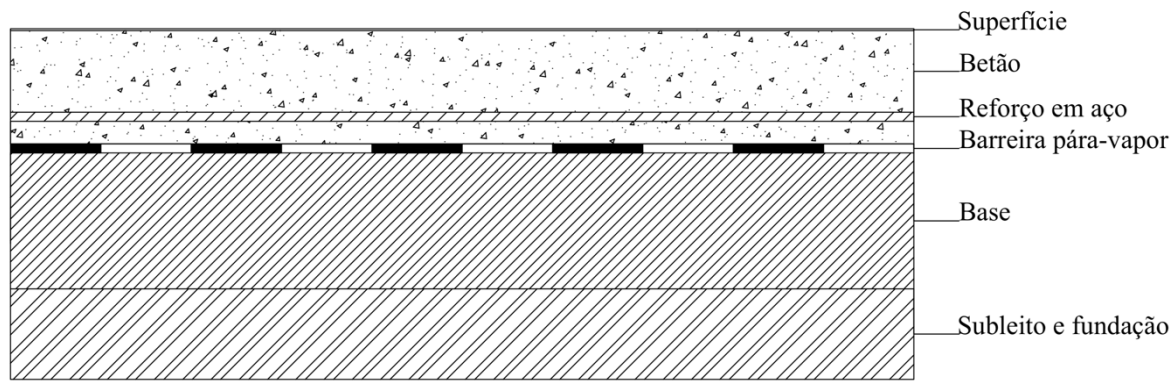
Corte ilustrativo de um pavimento térreo [adaptado 34]
